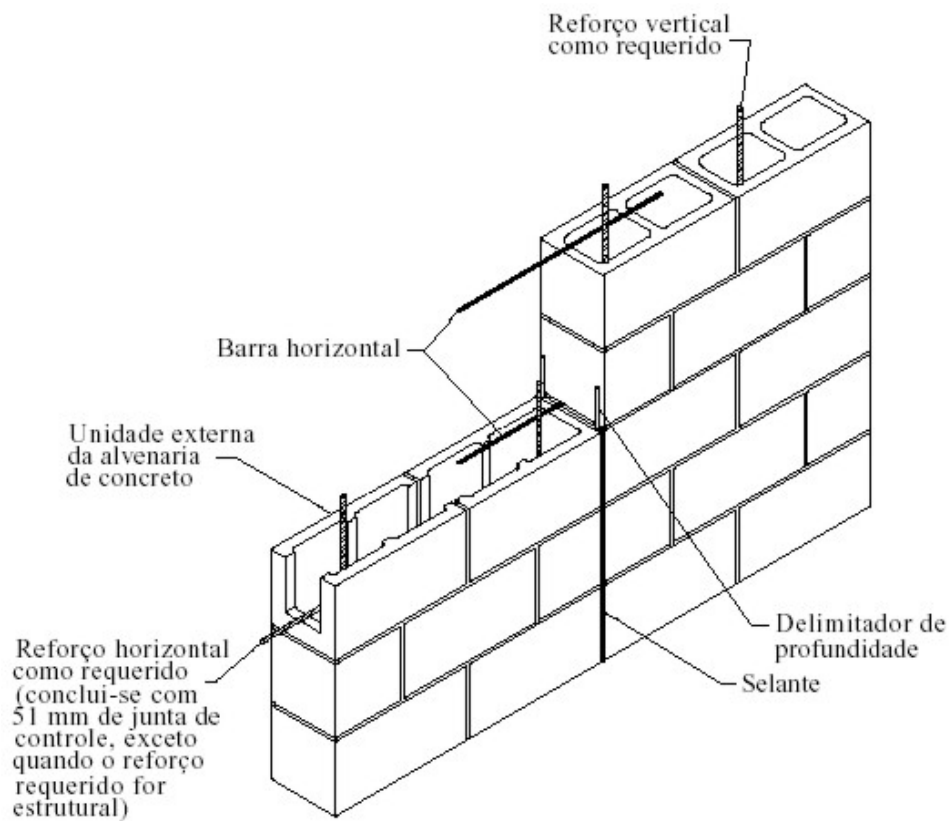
Juntas com barras (NATIONAL CONCRETE MASONRY ASSOCIATION, 2003a e 2003b)
